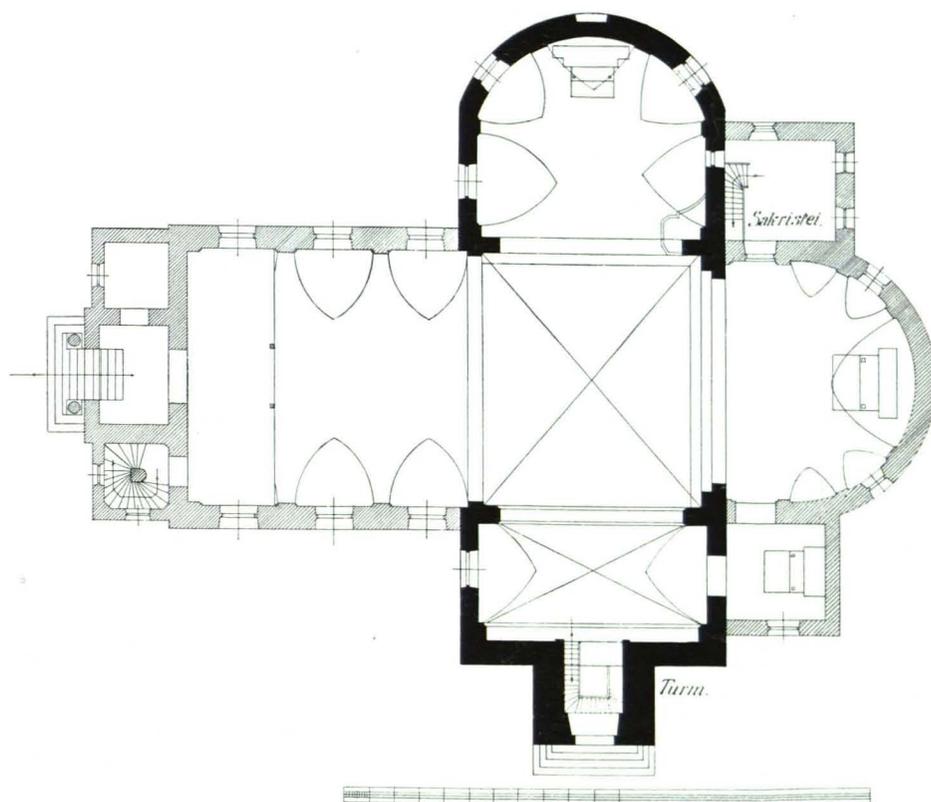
Aigen, Pfarrkirche, Grundriß 1:300 (S. 5)
